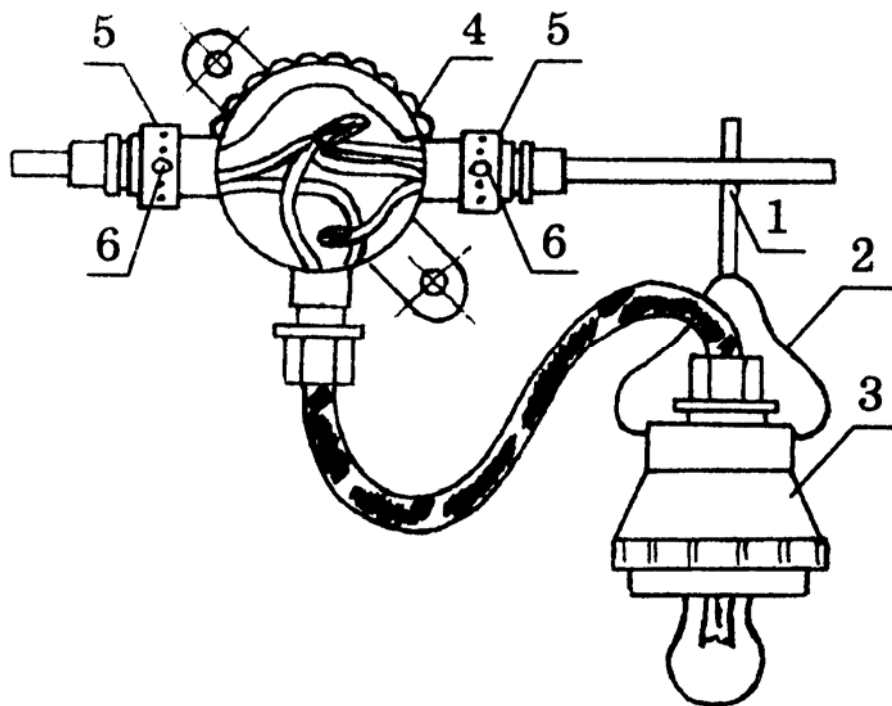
Раздельное крепление ответвительной коробки и светильника к несущему тросу:
